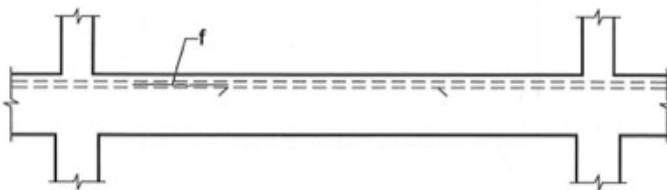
Fisura de anclaje en corte de armadura de momentos negativos en viga (Fuente: Calavera, 2005)
